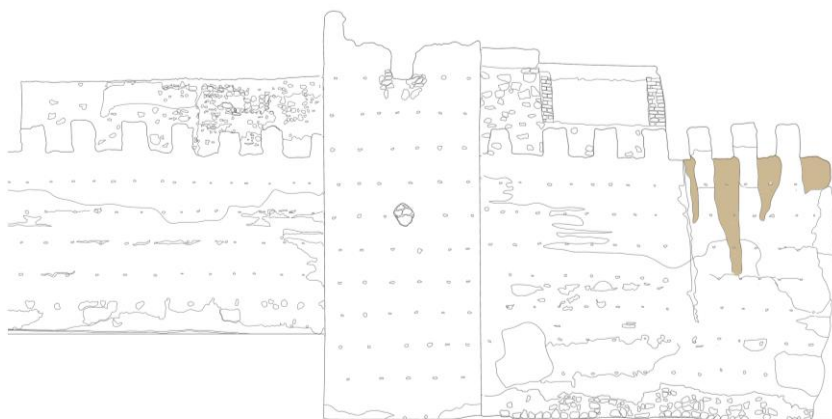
Alzado Norte con humedades entre almenas. Escala 1/200. Fuente: Autora.
